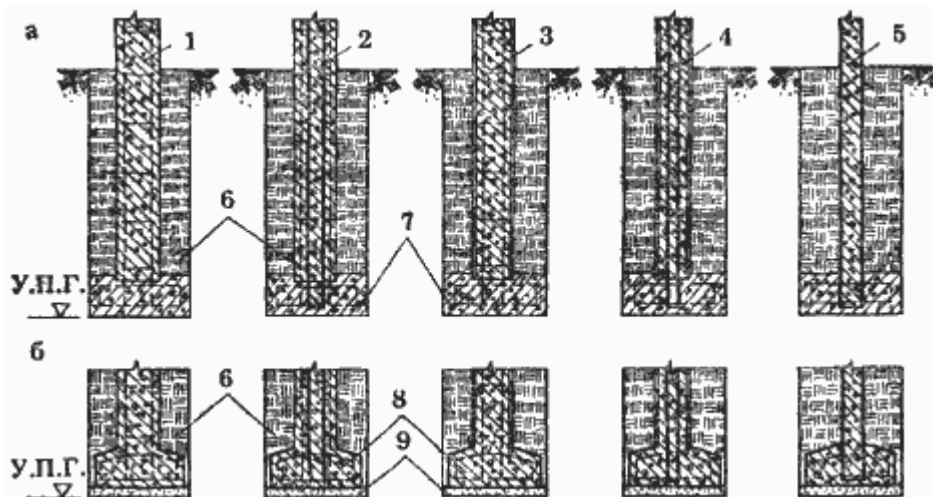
Столбчатые фундаменты, устраиваемые в глубоко промерзающих пучинистых грунтах: а - сборно-монолитные при расположении грунтовых вод в момент производства работ ниже подошвы фундаментов; б - сборные при любом расположении грунтовых вод; 1- сборный железобетонный опорный столб со стержневым арматурным каркасом; 2 - то же, с сердечником из стальной трубы; 3 - то же, со стержневым арматурным каркасом и оболочкой из асбестоцементной трубы; 4 - то же, с сердечником из стальной трубы и оболочкой из асбестоцементной трубы; 5 - сборный опорный столб из стальной трубы; 6 - засыпка вынутым грунтом; 7 - опорная плита из монолитного железобетона; 8 - опорная плита сборного железобетонного фундамента; 9 - песчаная подушка.
